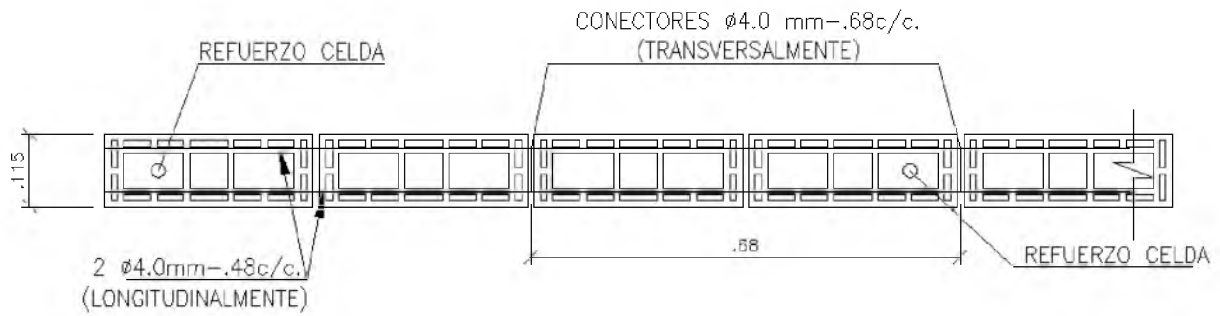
Corte Transversal de Muros (Refuerzo Transversal para todos los Muros en todos los pisos)
